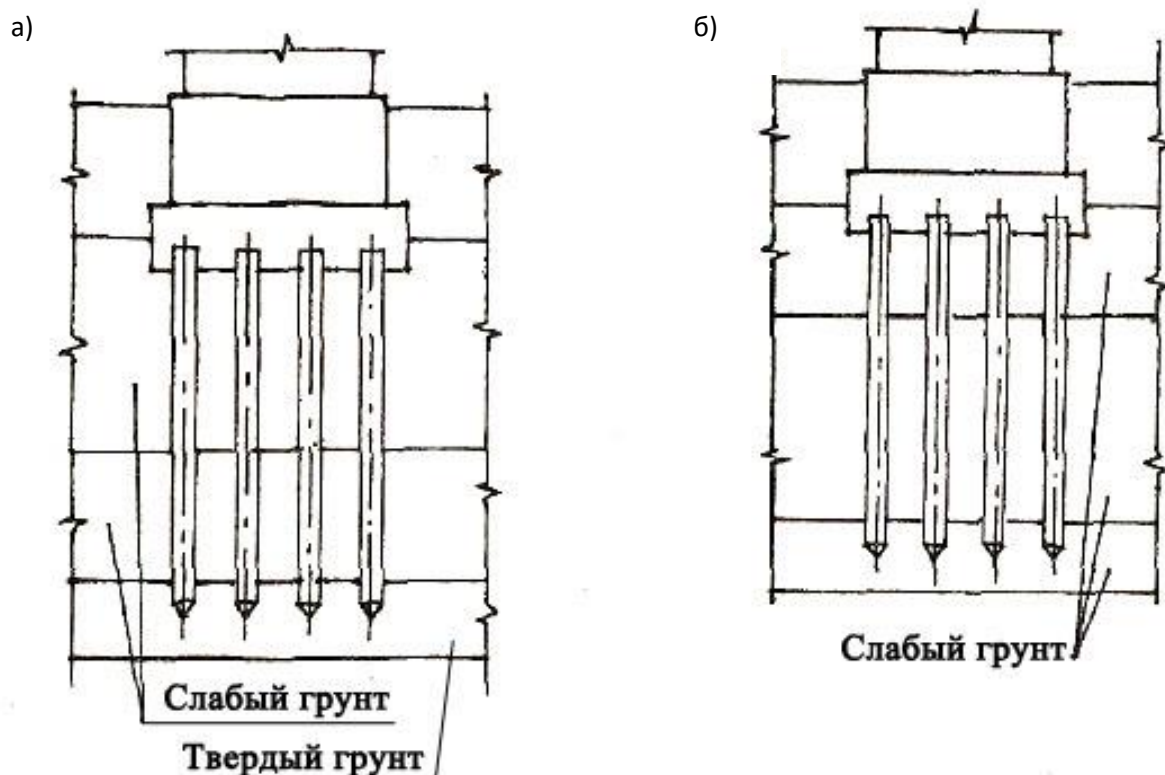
Статические схемы фундаментов свайных конструкций:
